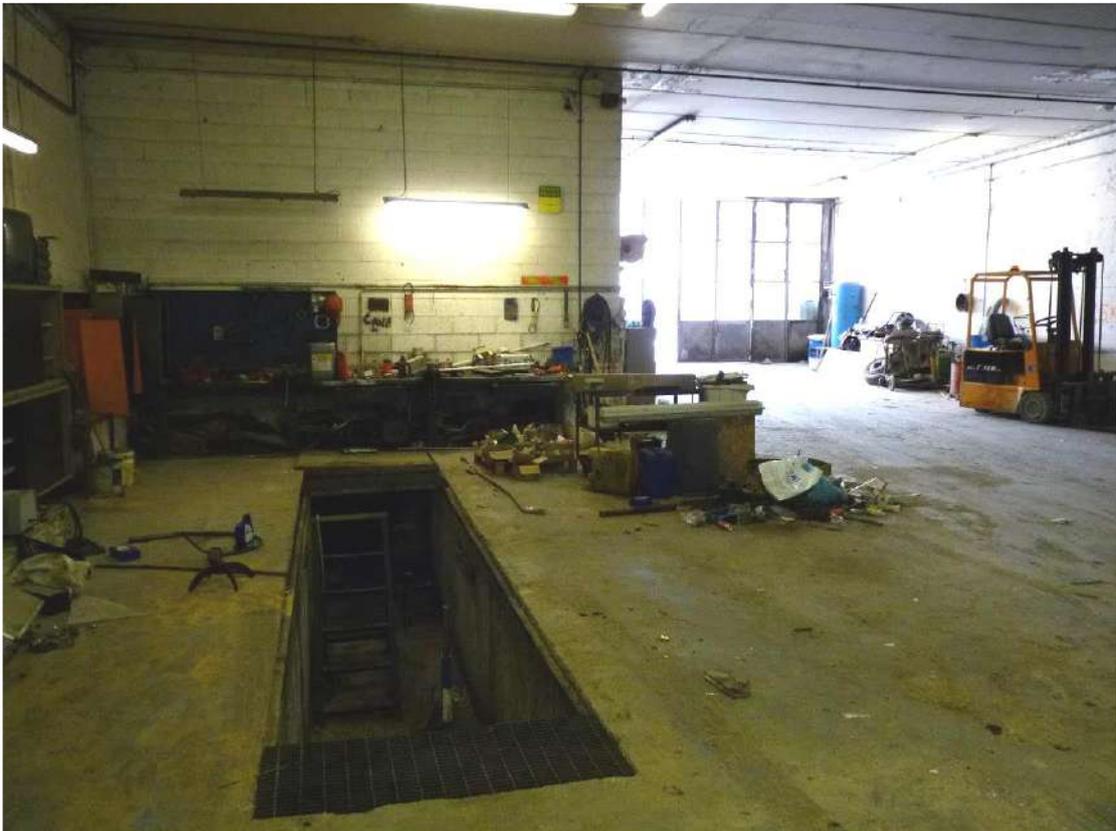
Locale magazzino (sub.25) (porzione centrale vista verso zona di ingresso di proprietà ██████████)
